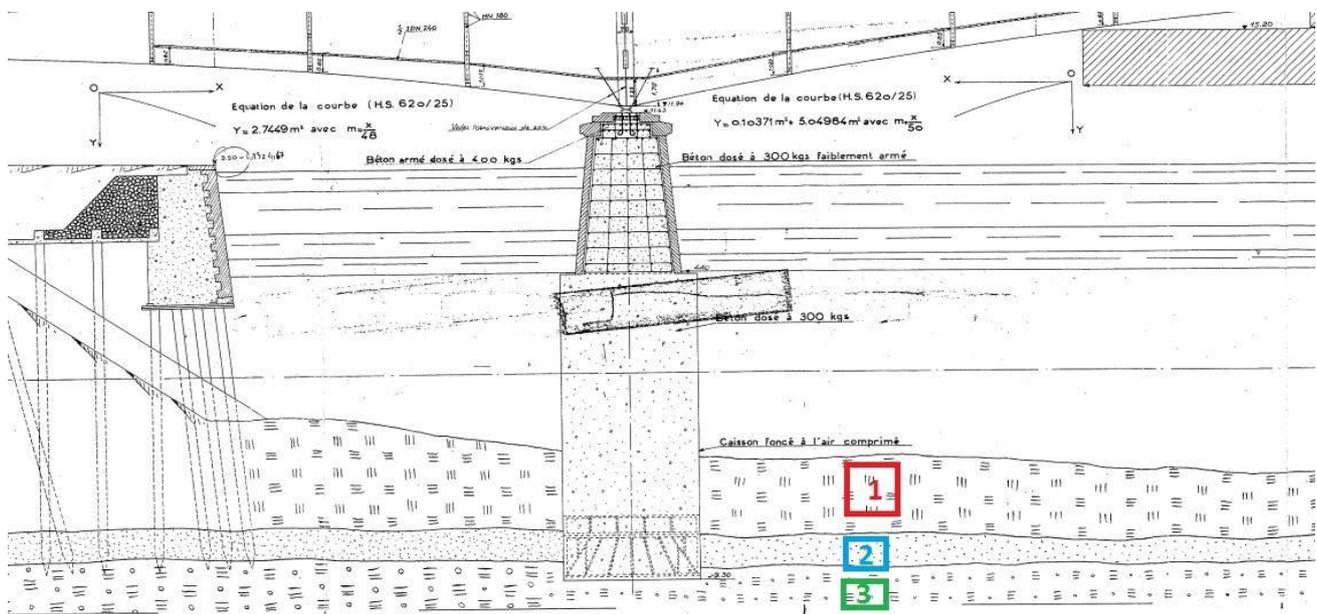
Coupe longitudinale du pont dans les plans d'origine avec 1 sable calcaire, 2 sables siliceux et 3 marne calcaire bleue
